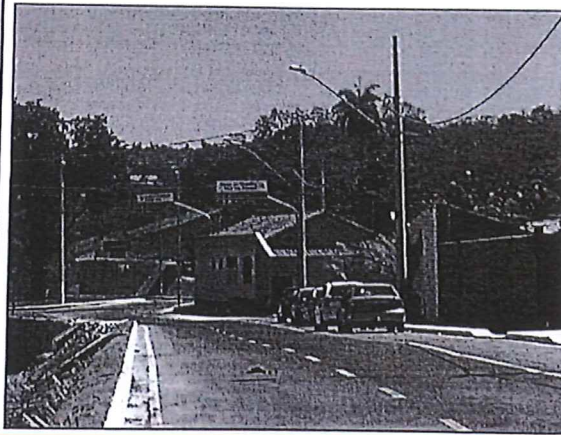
Ilustra outro trecho da Avenida Júlio Clóvis de Lacerda.
